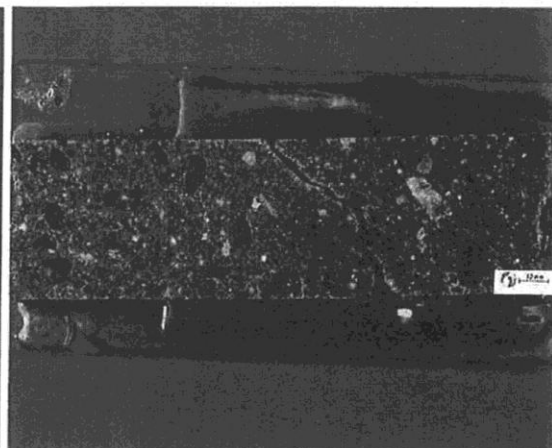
Bildet viser planslipet av kjerne D4/5. Kjerne "biten" D5 er til høyre i bildet
